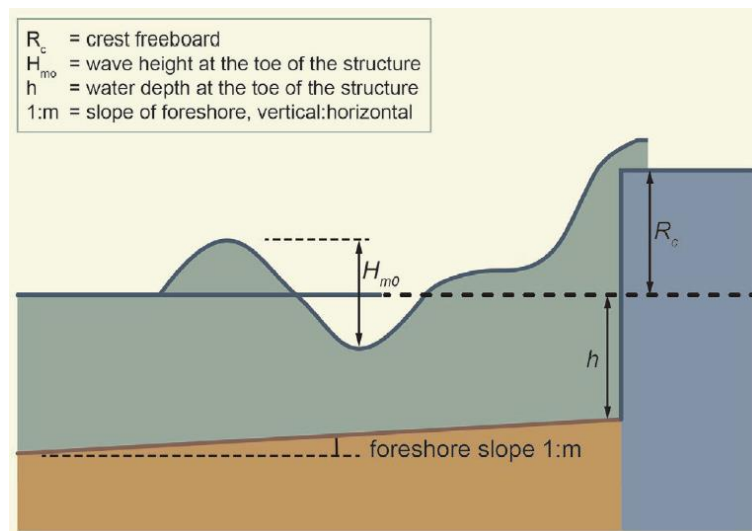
Schema tipologico per il calcolo della tracimazione di strutture a parete verticale
